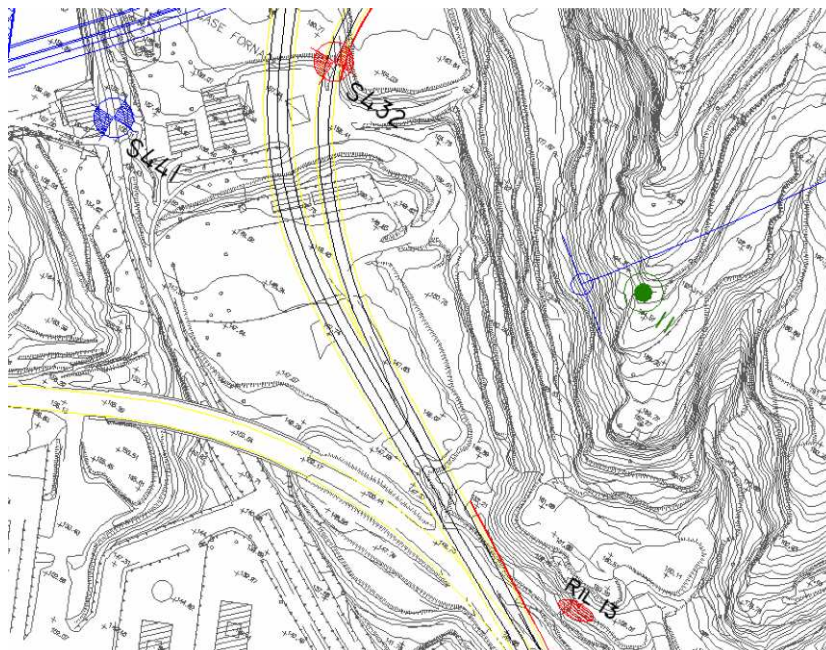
Ubicazione in planimetria dell'affioramento oggetto del rilievo geostutturale
